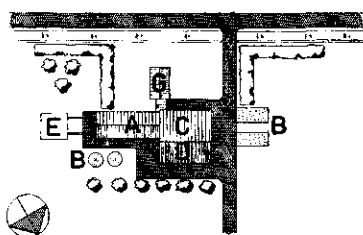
Plan G: erfindeling van een situatie met een woning verbonden aan het bedrijfsgebouw
